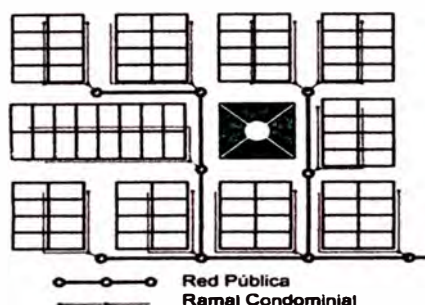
Sistema de Alcantarillado Condominial
